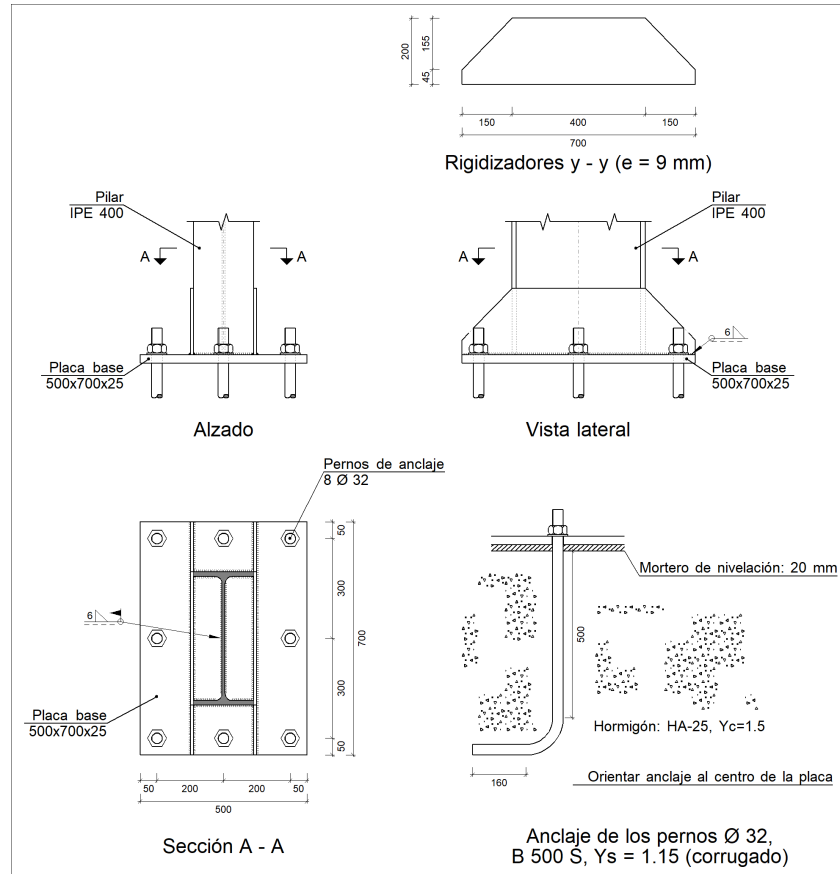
Detalle placa de anclaje tipo 1 (Fuente: CYPE 3D)
